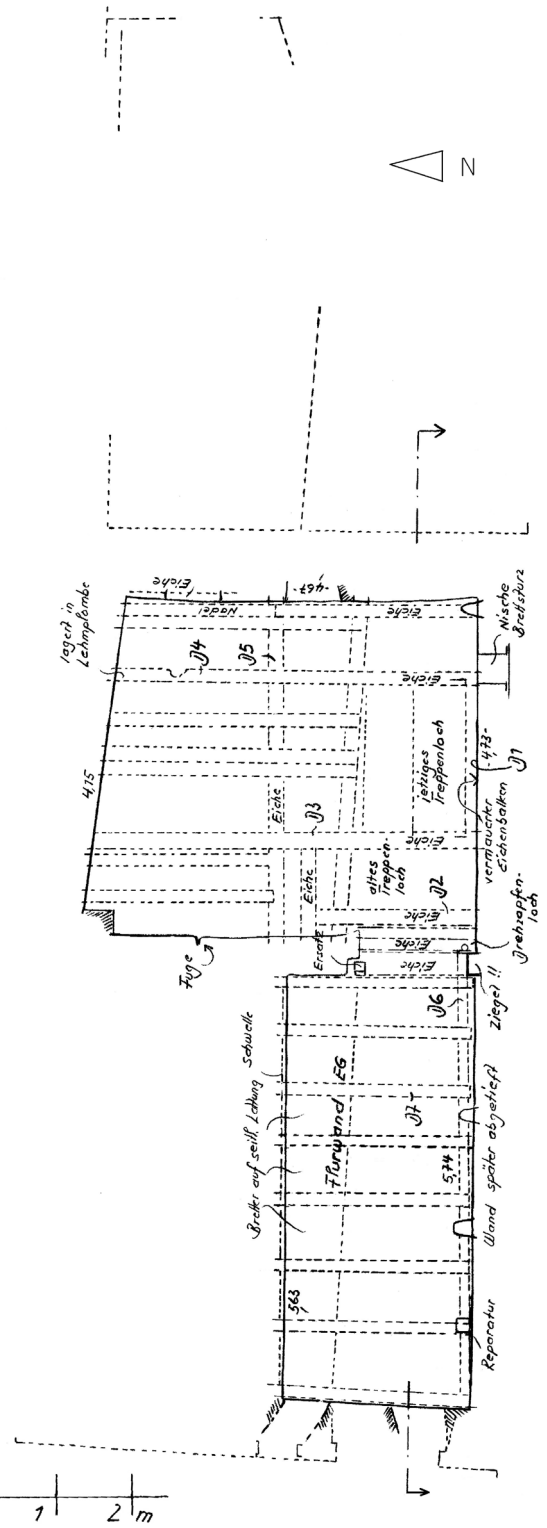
Adlegasse 3, Grundriss Keller.
